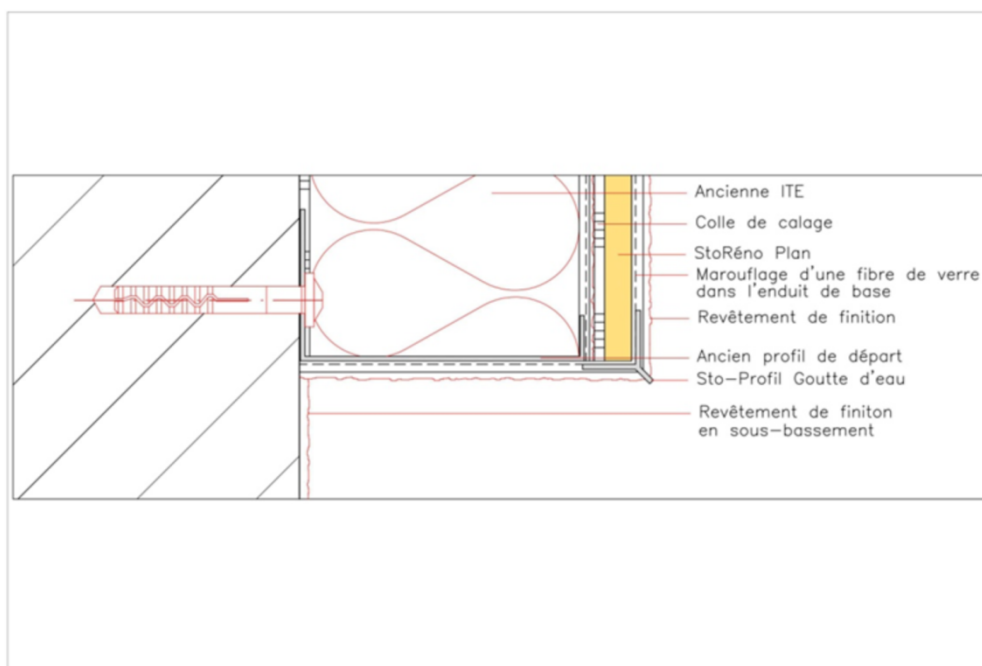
Arrêt bas (variante 1) – Départ avec Sto Profil goutte d'eau
